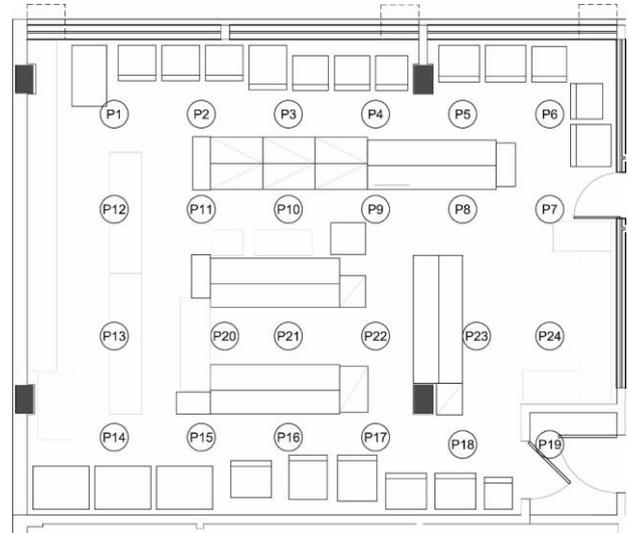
Planta esquemática dos pontos de medição da sala 525, Pav. Rocha Lima. Sem escala.
